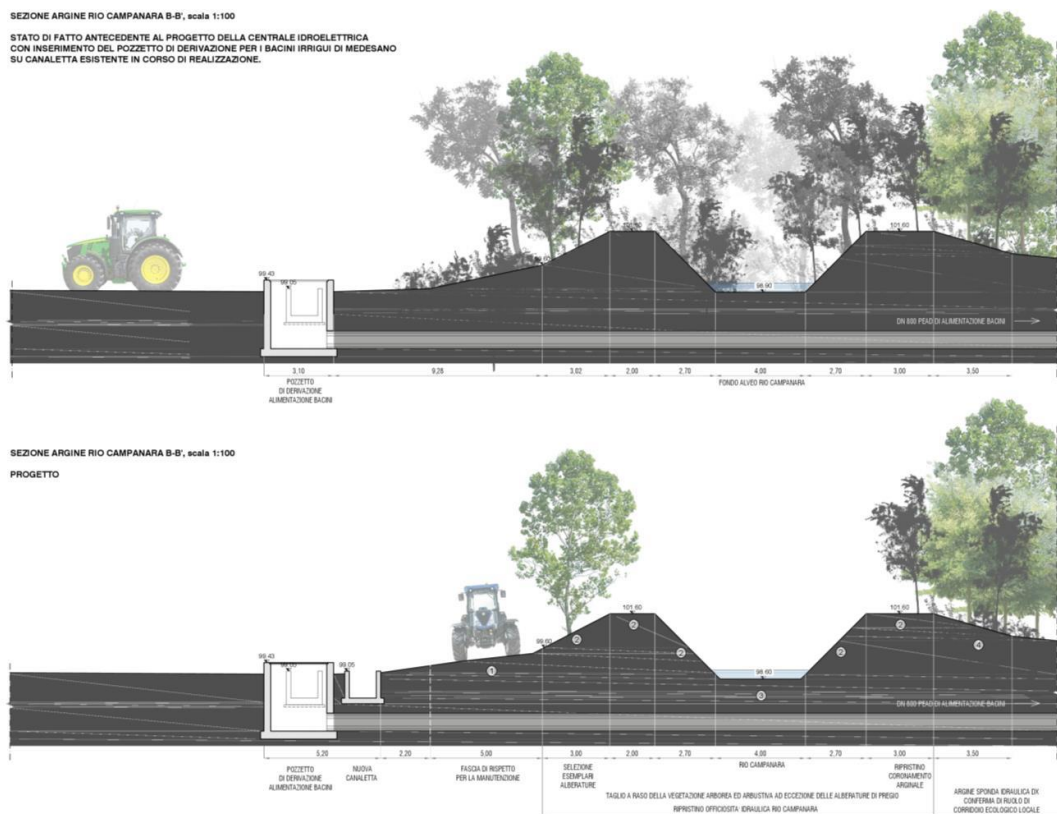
SEZIONE ALVEO ARGINATO DEL RIO CAMPANARA PRIMA E DOPO L'INTERVENTO DI MANUTENZIONE PREVISTA IN PROGETTO
